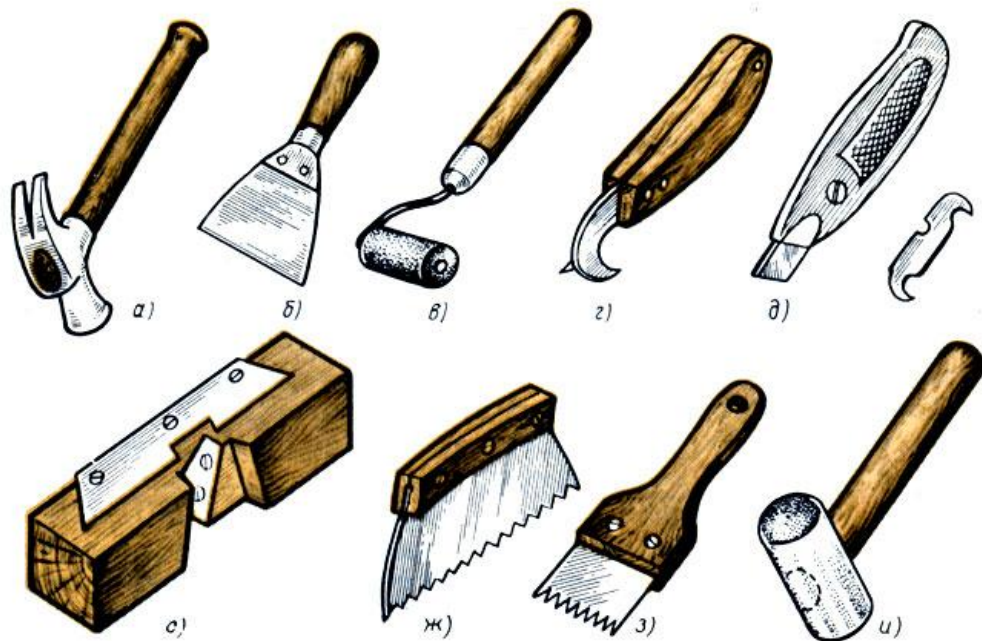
Инструмент для укладки линолеума: а - молоток металлический, б - шпатель стальной, в - валик линолеумный, г - нож линолеумный, д - нож линолеумный со сменными лезвиями, е - приспособление для прирезки кромок линолеума, ж - шпатель зубчатый большой, з - шпатель зубчатый малый, и - резиновый молоток
